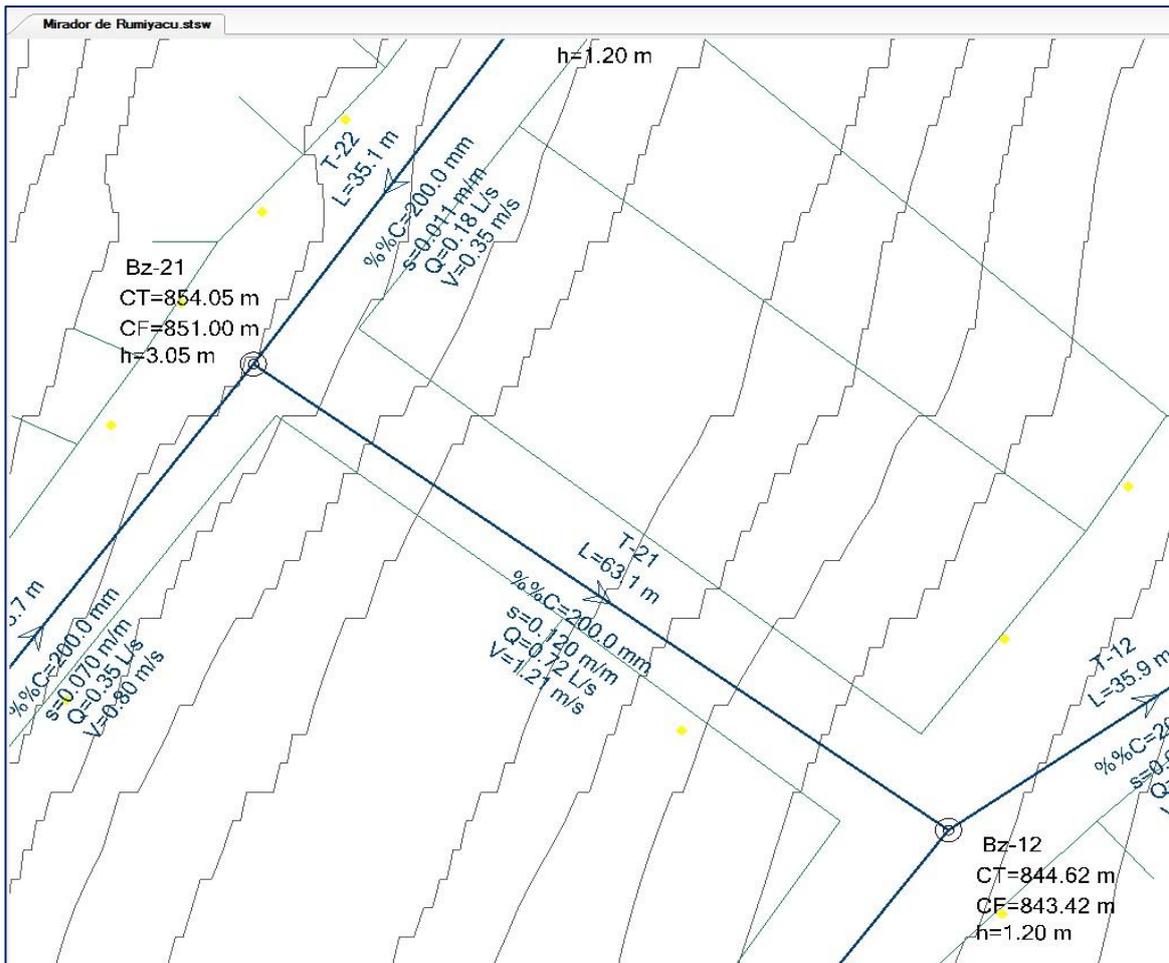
Vista de planta del buzón 21 al 12. (Fuente: Software SEWERCAD).
